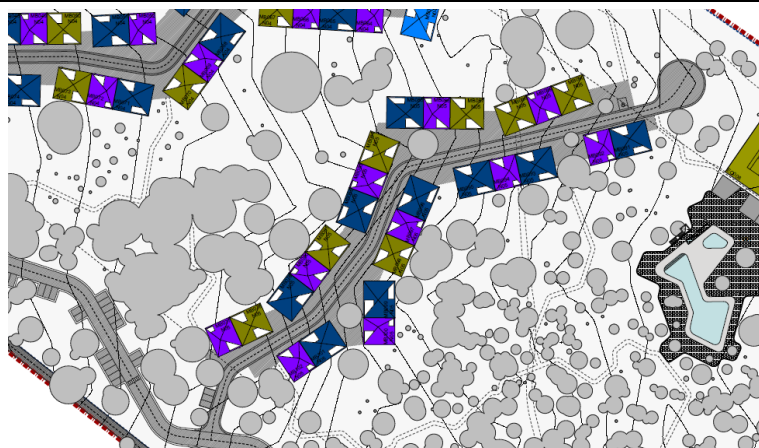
Arruamento com moradias em banda (MB) (pormenor da planta de projeto, s/escala)
